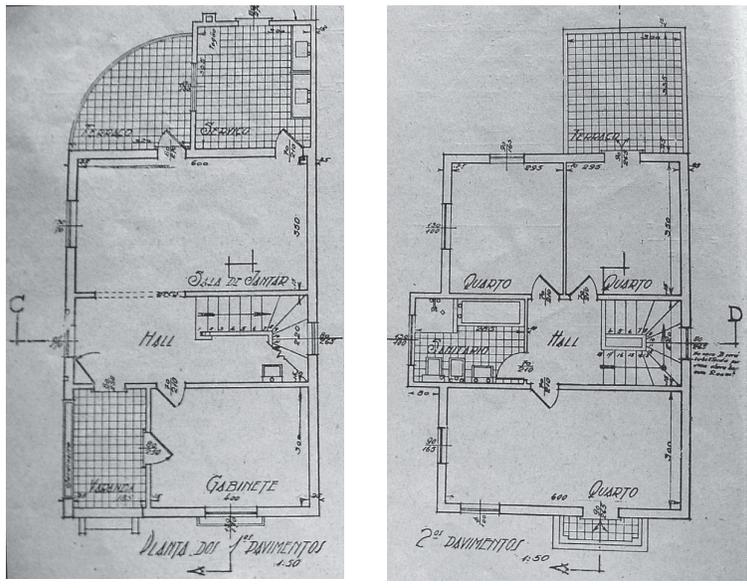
A e B – Planta do 1º. e 2º. pavimento. Fonte: Técnica (nº.2, 1941).
